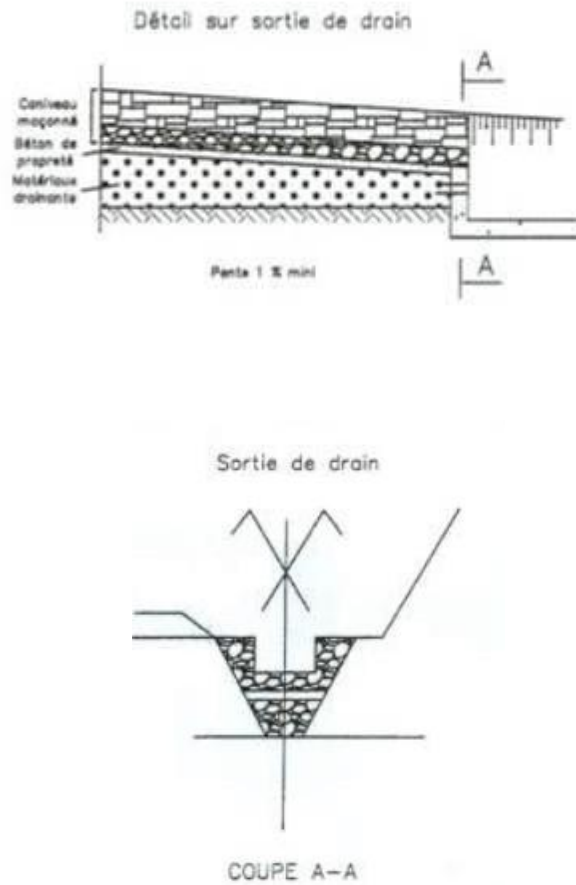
PROFIL EN TRAVERS DE DRAIN
